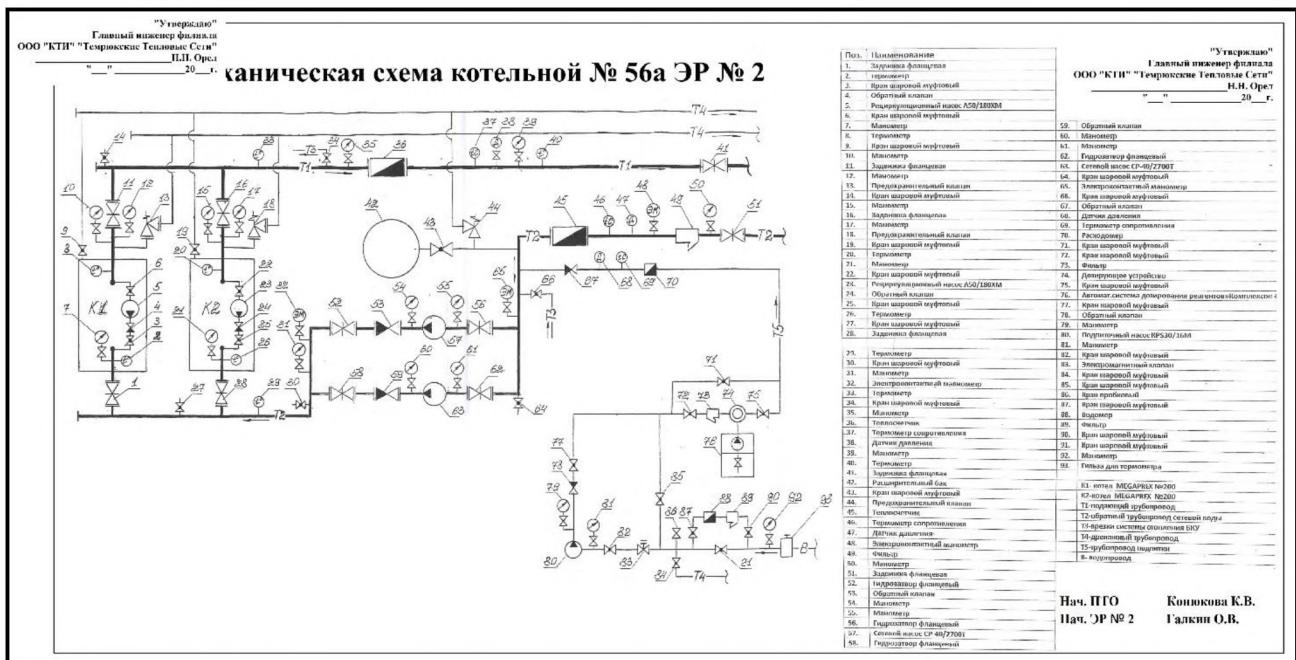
Тепломеханическая схема Котельной №56а, п. Веселовка
